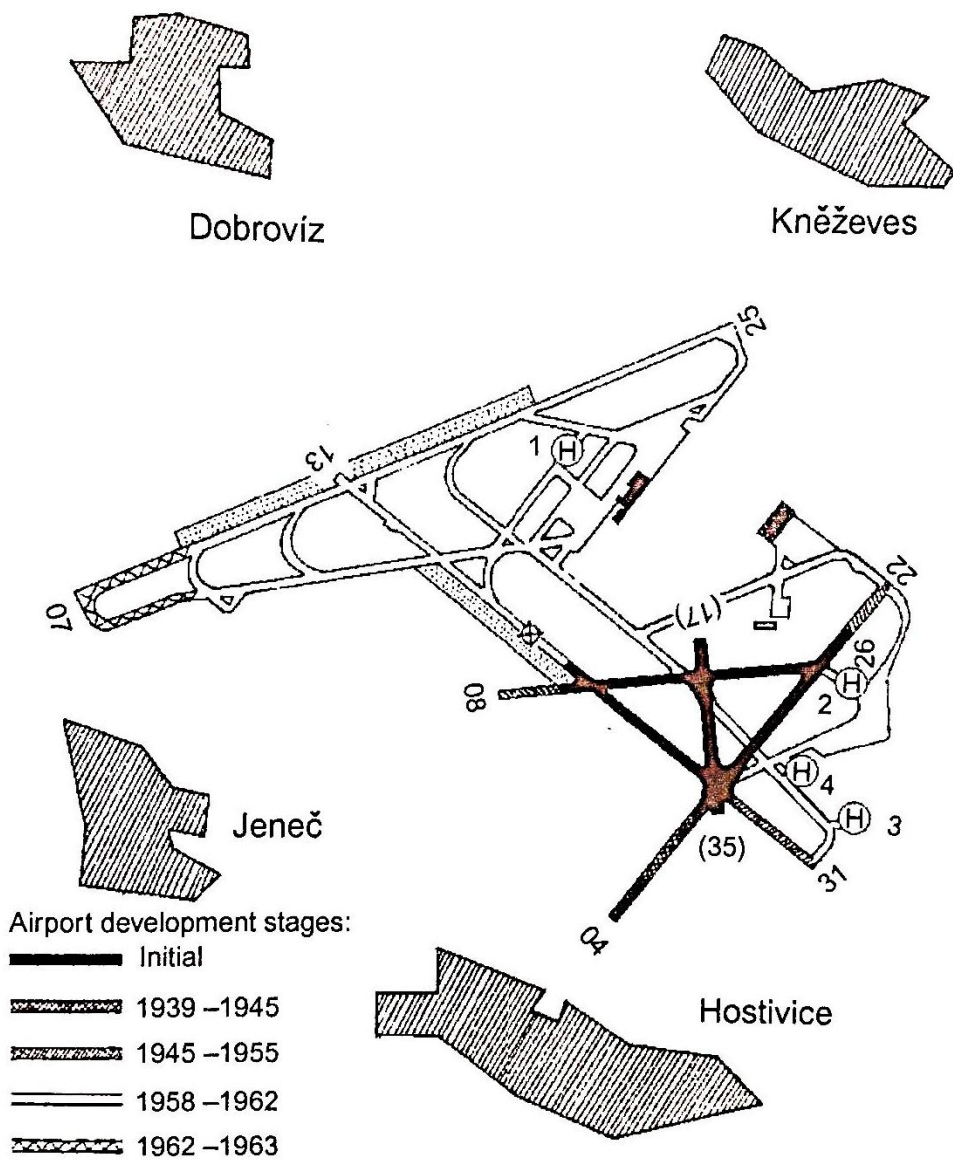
Praha – Ruzyně konstrukce RWY 04-22 z roku 1938 [1]
